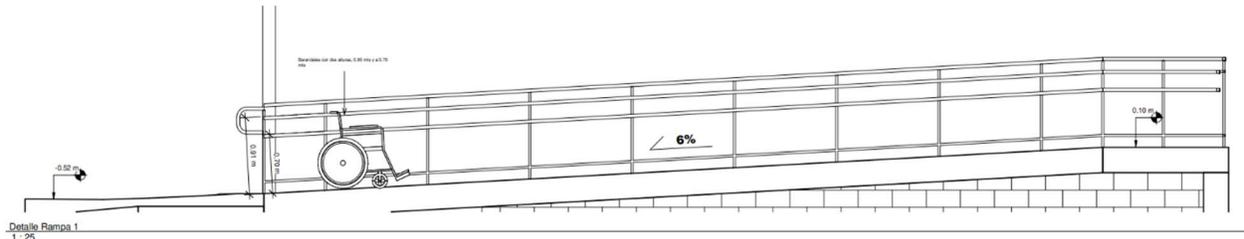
Detalle de rampa del proyecto propuesto. Fuente: Elaboración propia.
